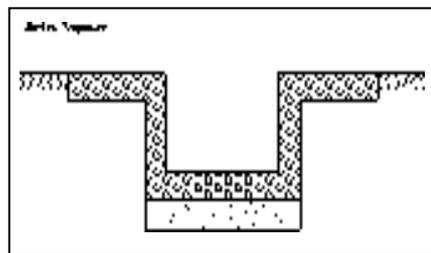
Drainase Trapesium Saluran Tanah.
